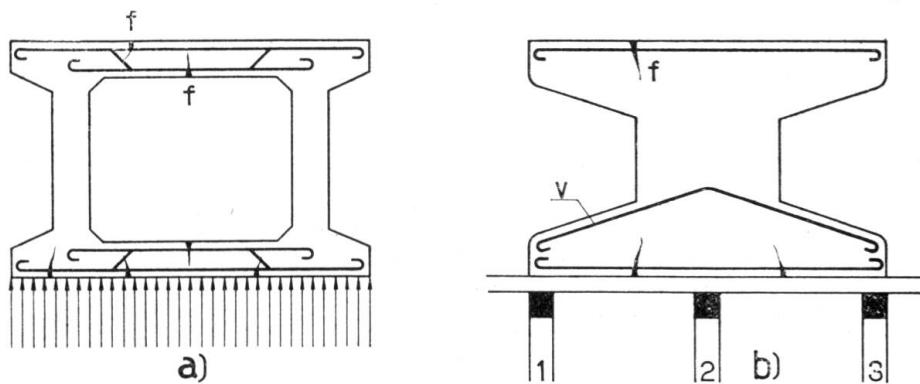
Esquema das secções dum arco vazado (a) e dum arco aligeirado (b). Localização das possíveis fendas
